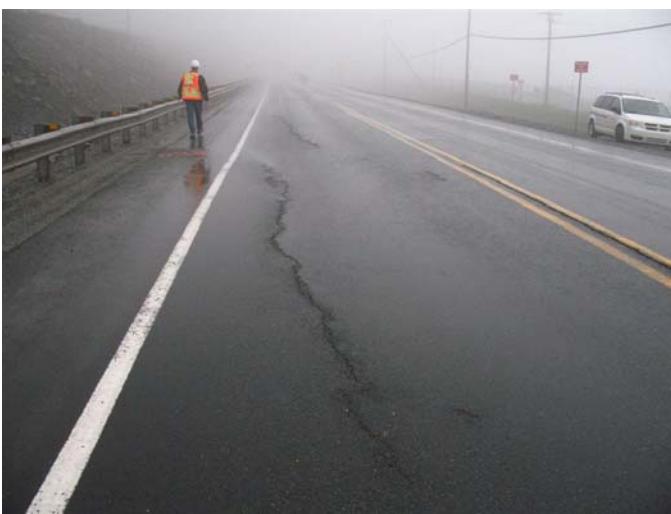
Fissuration et déformation du chemin temporaire dans le secteur *nord*.
